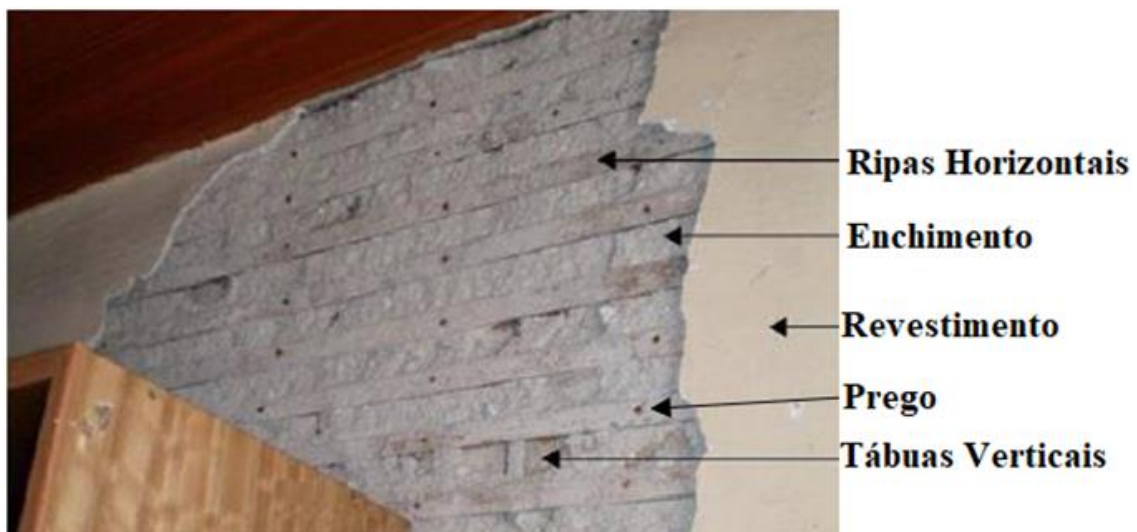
Exemplo de elementos construtivos de uma parede de tabique (adaptado [3])
